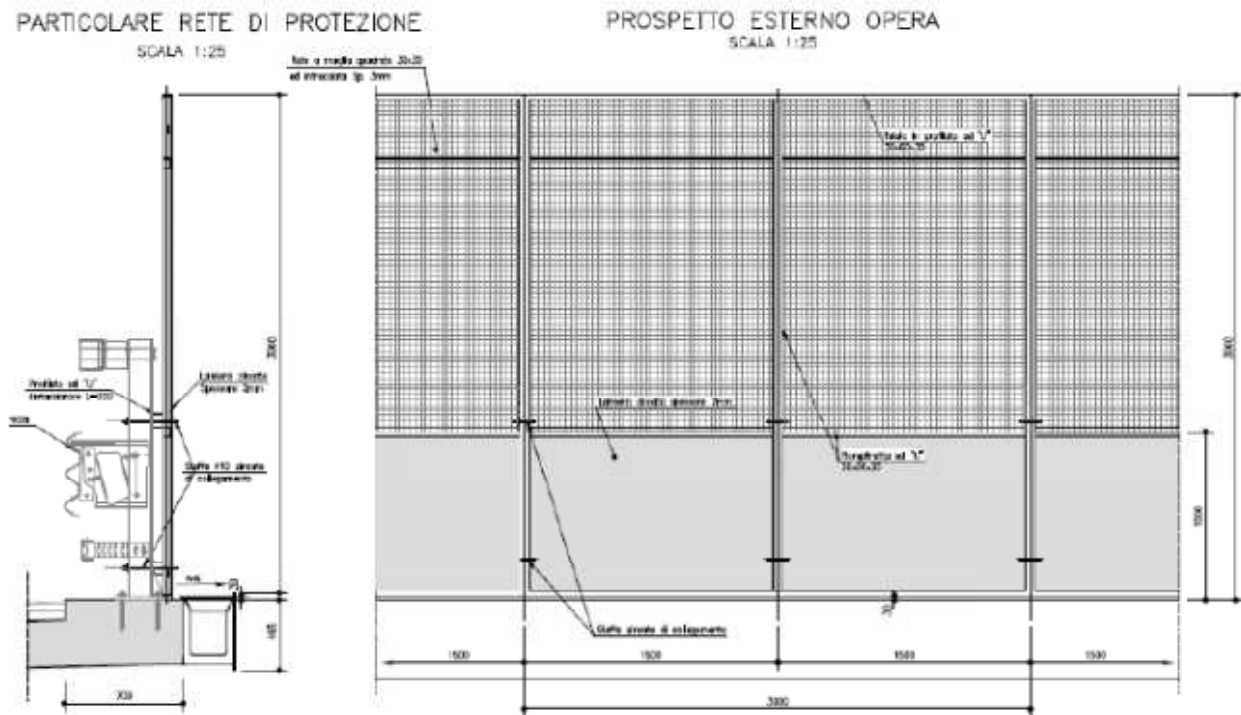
Sezione tipologica rete di protezione sui viadotti
